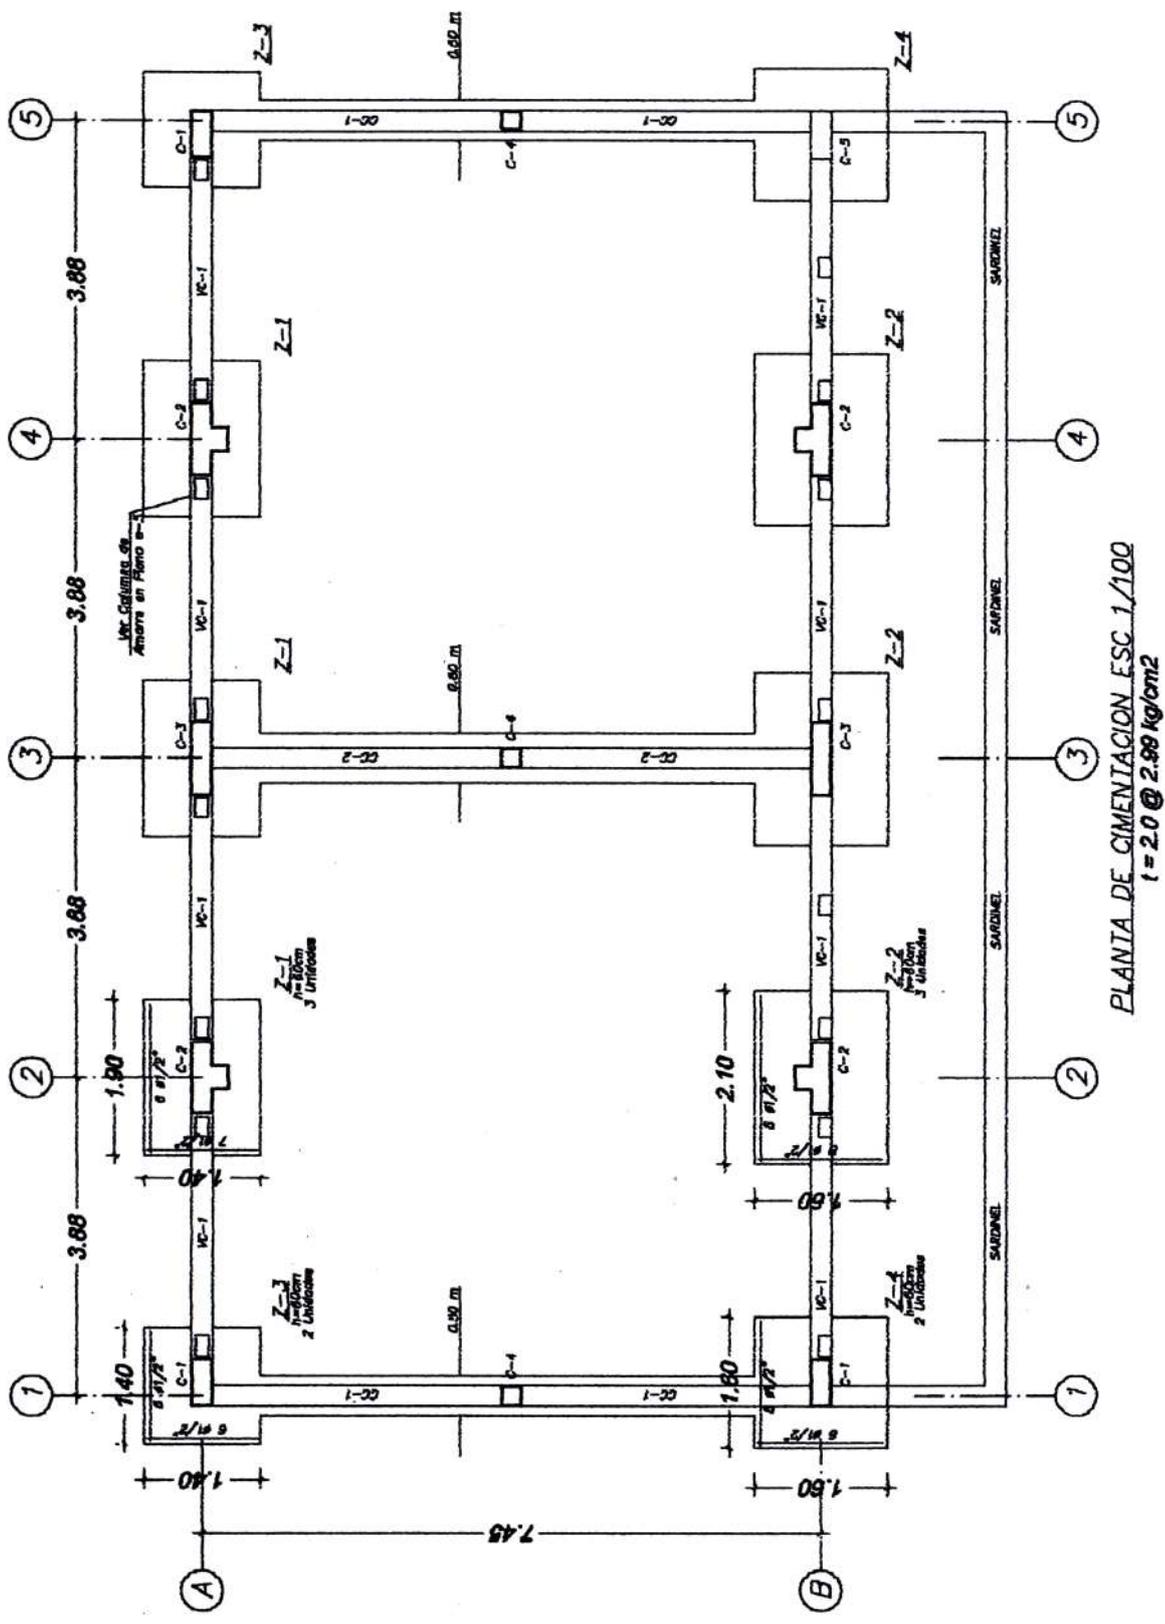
PLANTA DE CIMENTACION 2 AULAS-2 PISOS (CAPACIDAD PORTANTE TERRENO 2.0 – 2.99 Kg/cm²)
